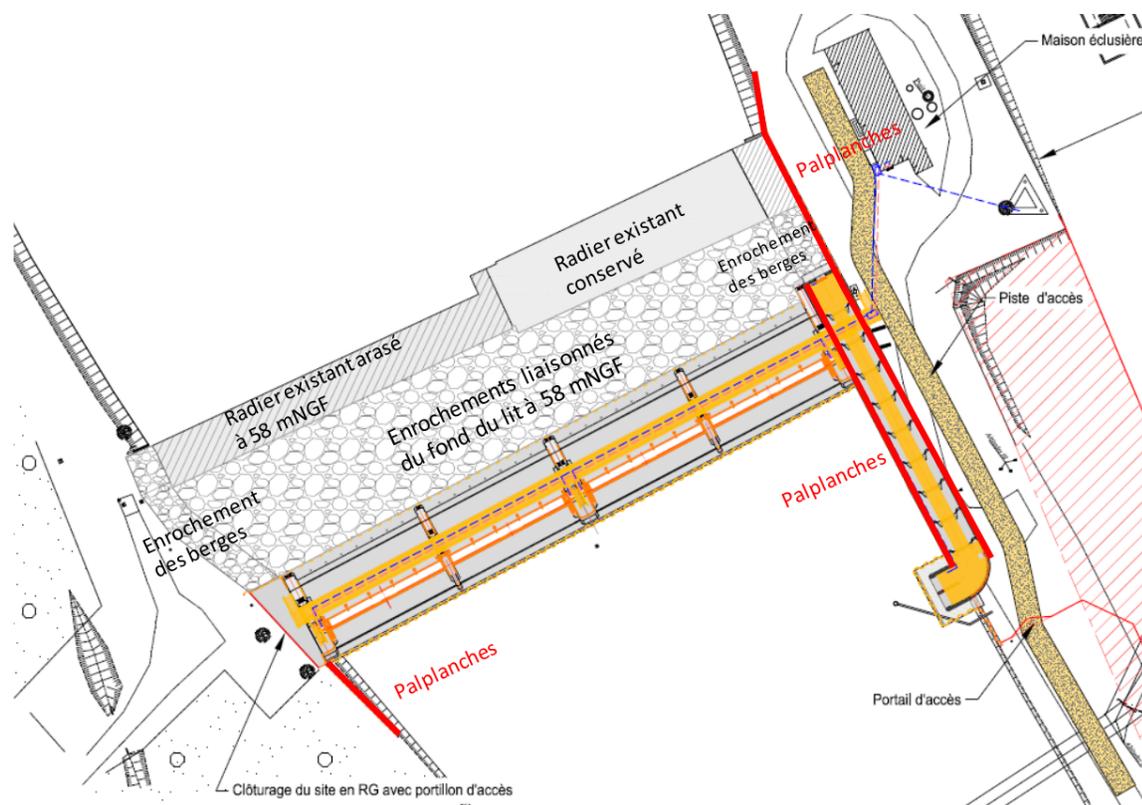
Bilan des modifications des berges et du fond du lit – vue en plan
